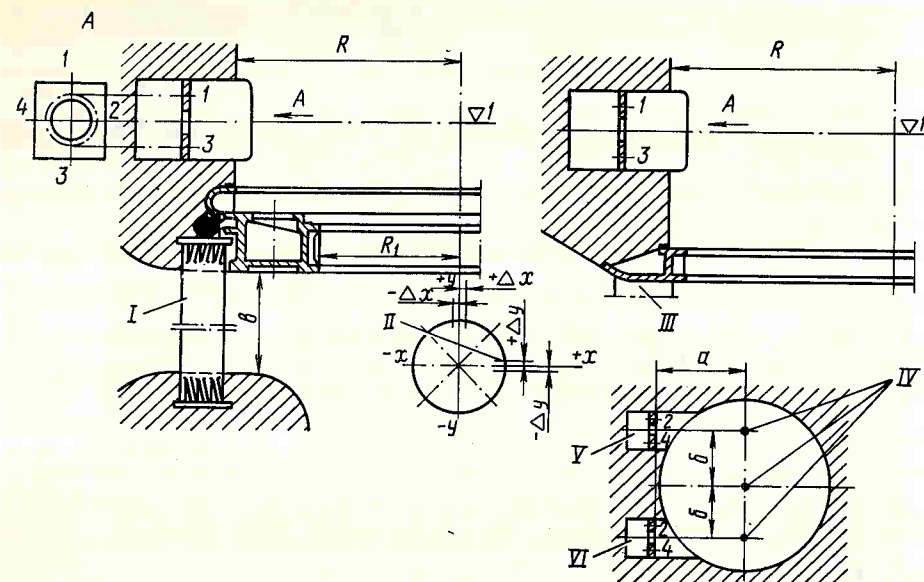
Формуляр установки верхнего узла закладных частей гидротурбины
